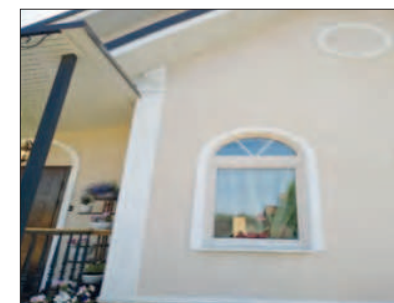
Фрагменты конструкций арочного перекрытия и гипсовой отделки фасада
